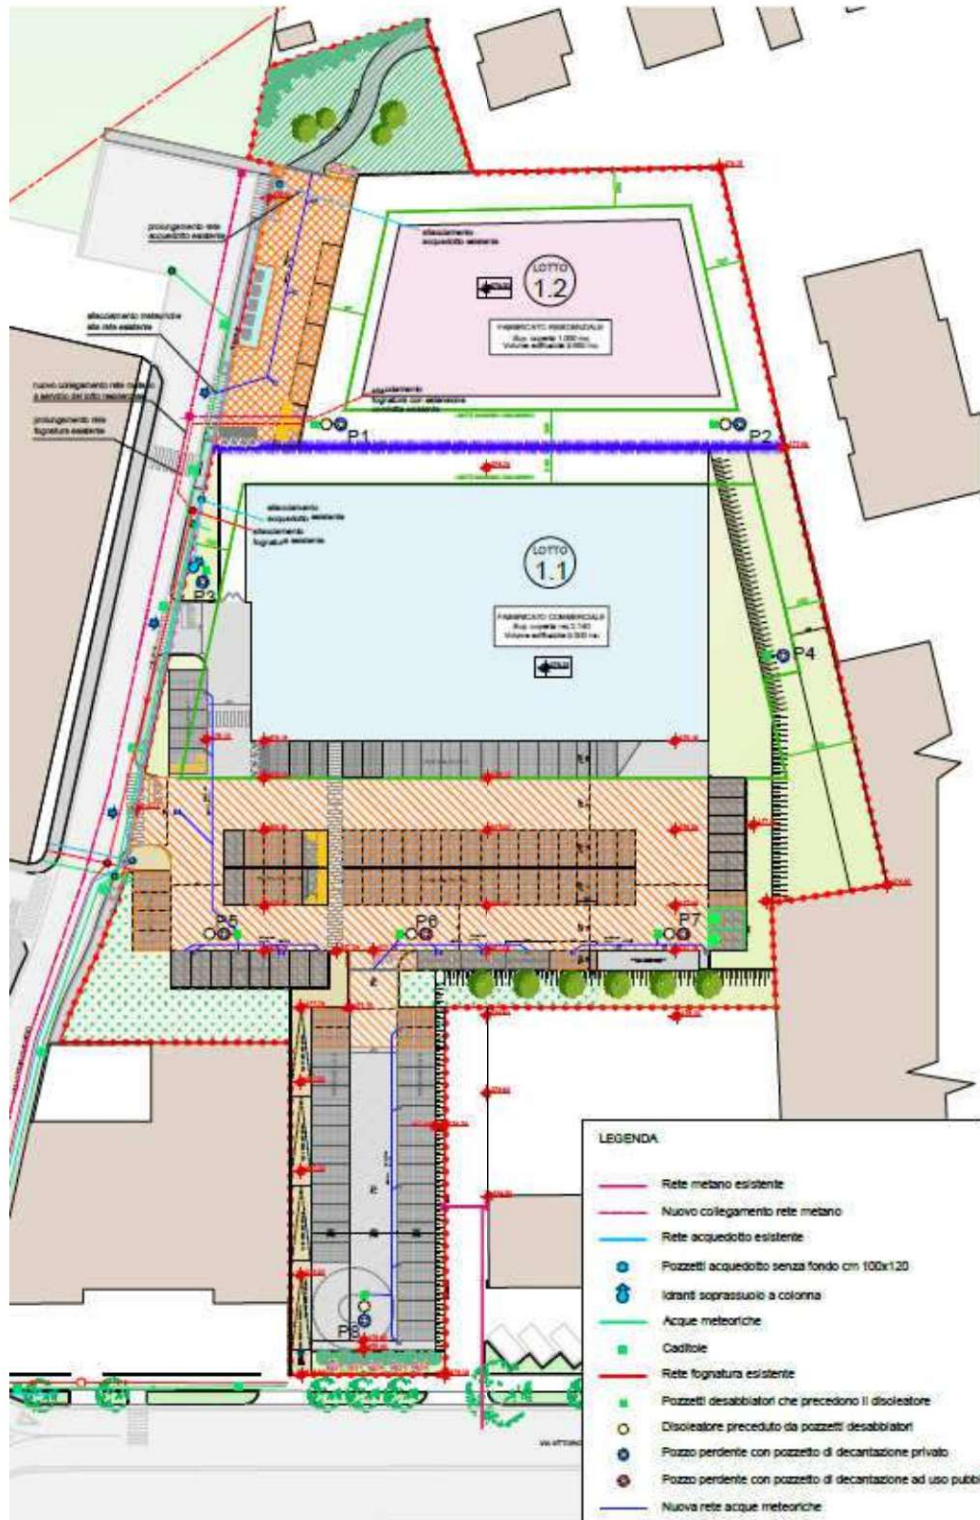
Planimetria con individuazione del bacino di scolo (perimetro rosso).
